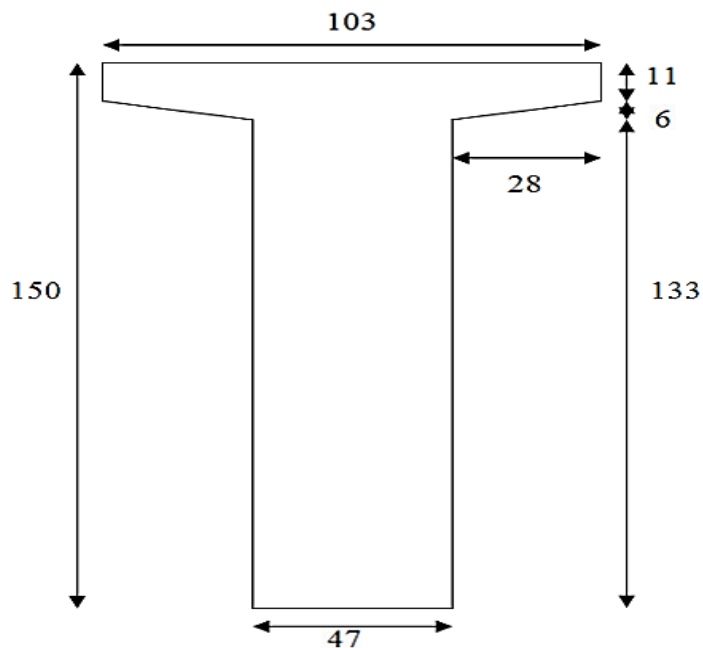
Figure IV-II : Section de la poutre en « T » sans hourdis à l'about.
